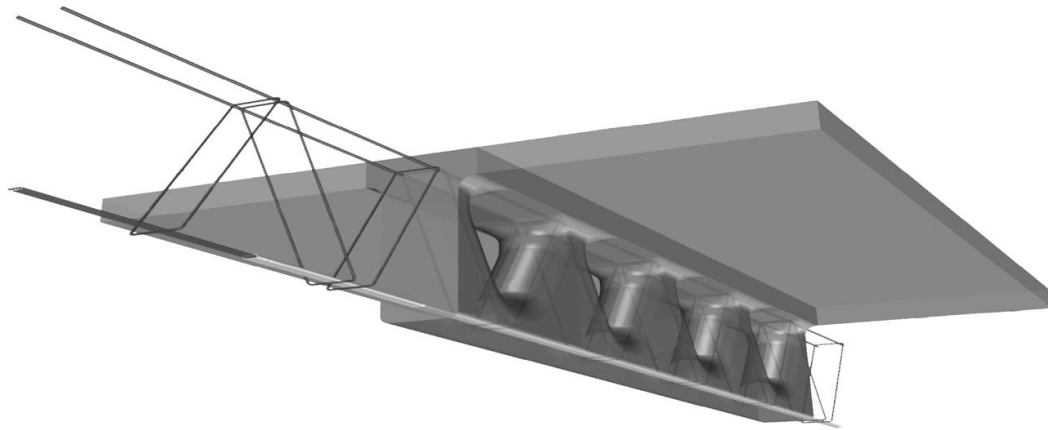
Detalle nervios forjado HOLEDECK Ho-One (HOLEDECK, 2018)
